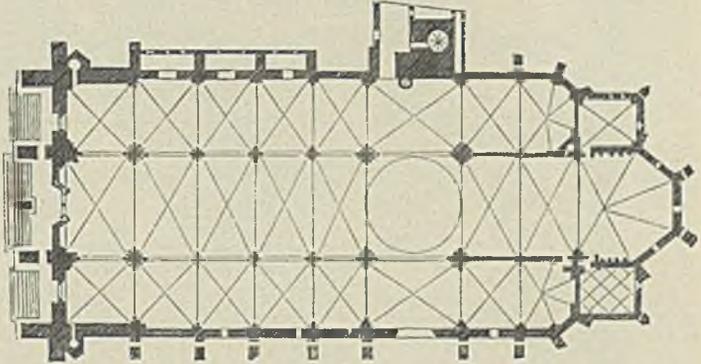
Grundriß einer Kirche mit deutschem Chorplan
